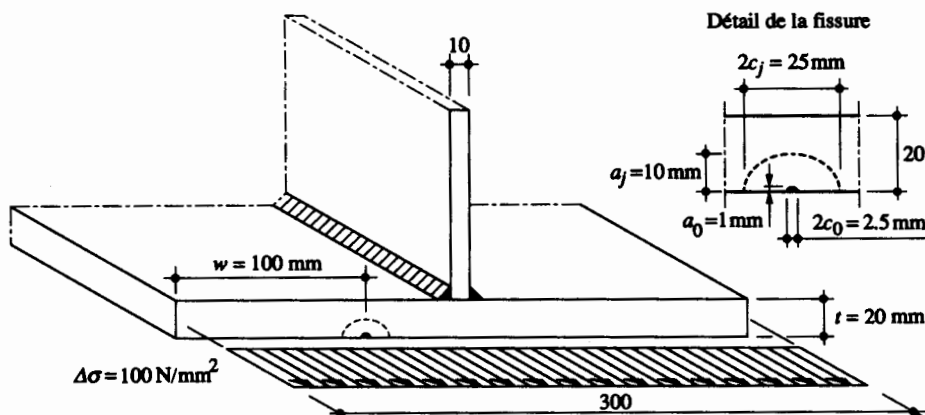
Fissure dans la section d'une poutre composée à âme pleine (la dimension initiale de la fissure n'est pas à l'échelle !).
